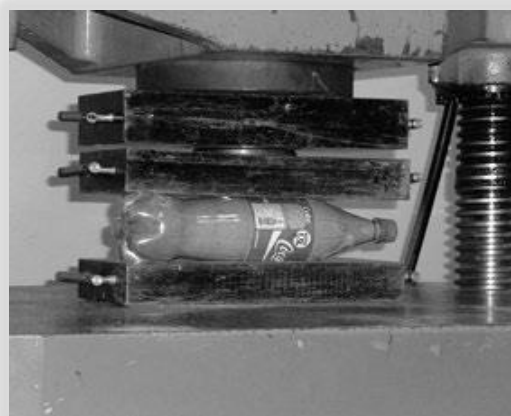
Prueba de resistencia a la compresión. Fuente: “Nuevas alternativas en la construcción: botellas PET.con relleno de tierra.”
